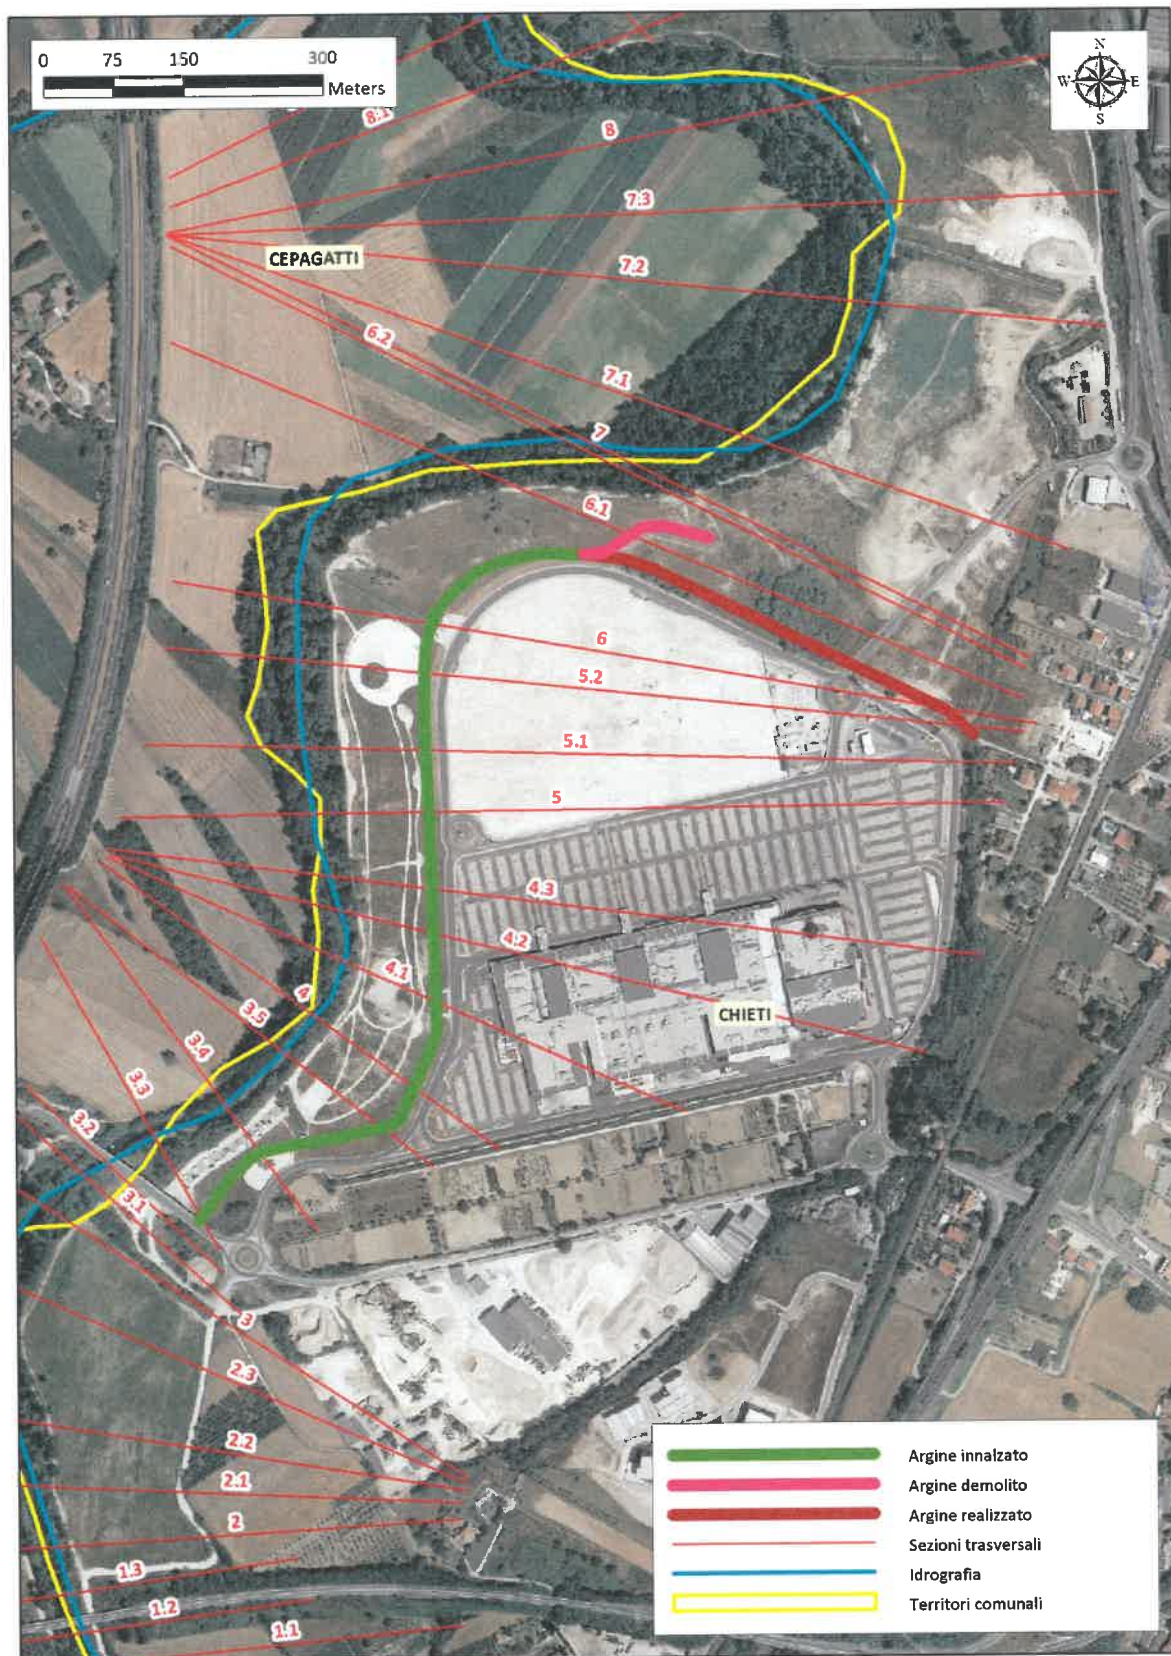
Planimetria dell'area di interesse con l'indicazione degli interventi realizzati su base ortofoto
